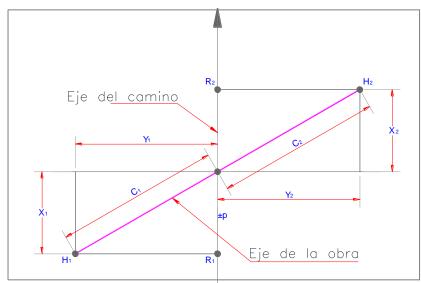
Elementos considerados en el cálculo de la longitud de obra, Ilustración, 2018.
